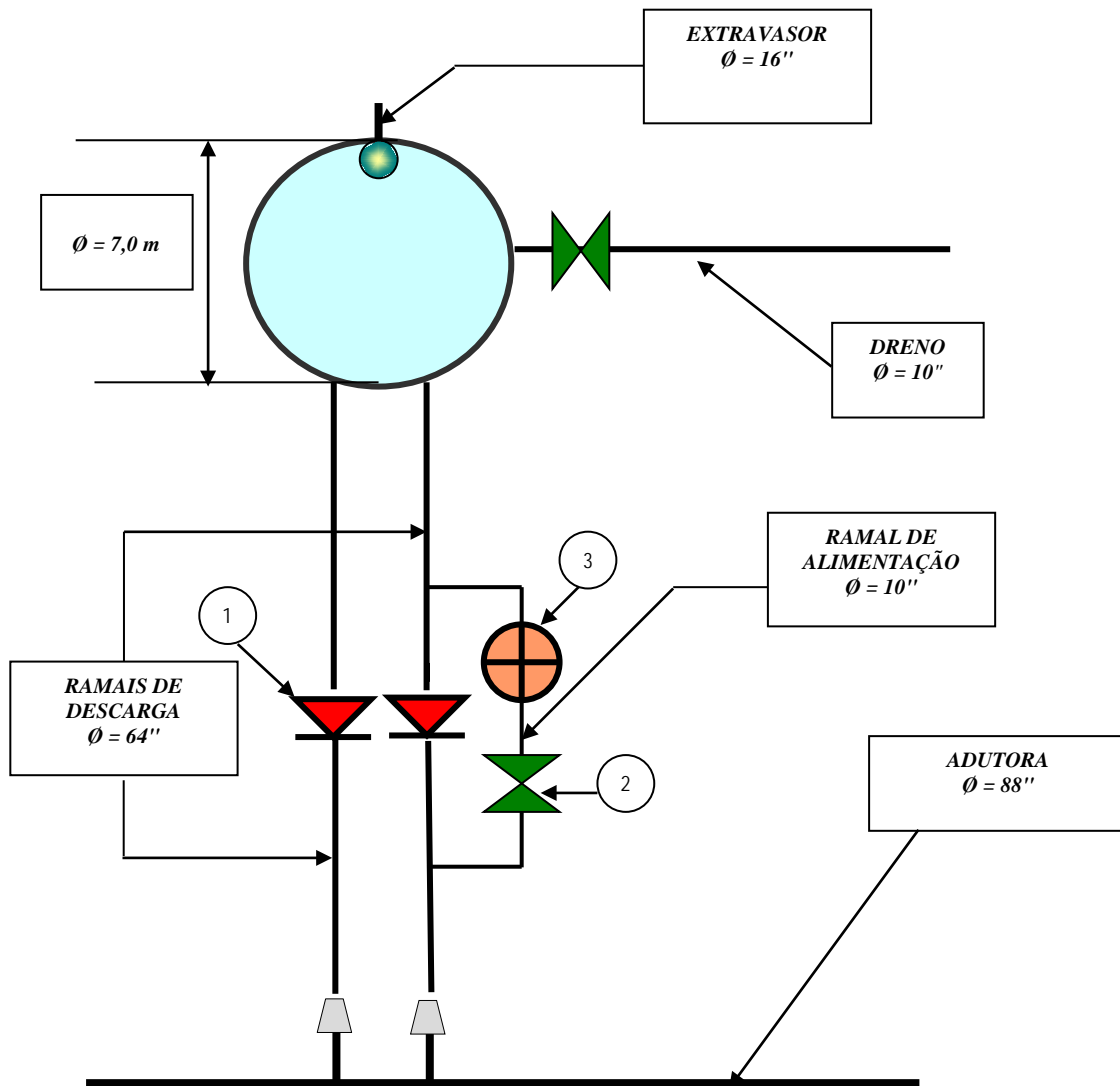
Planta do Esquema do Tanque de Amortecimento Unidirecional - TAU
